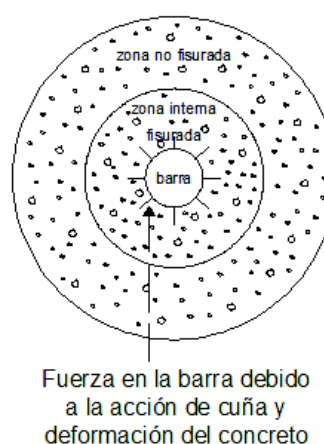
DEFORMACIONES Y FISURAS INTERNAS EN EL HORMIGÓN CON VARILLA DE REFUERZO CORRUGADA, GOTO (1971).
